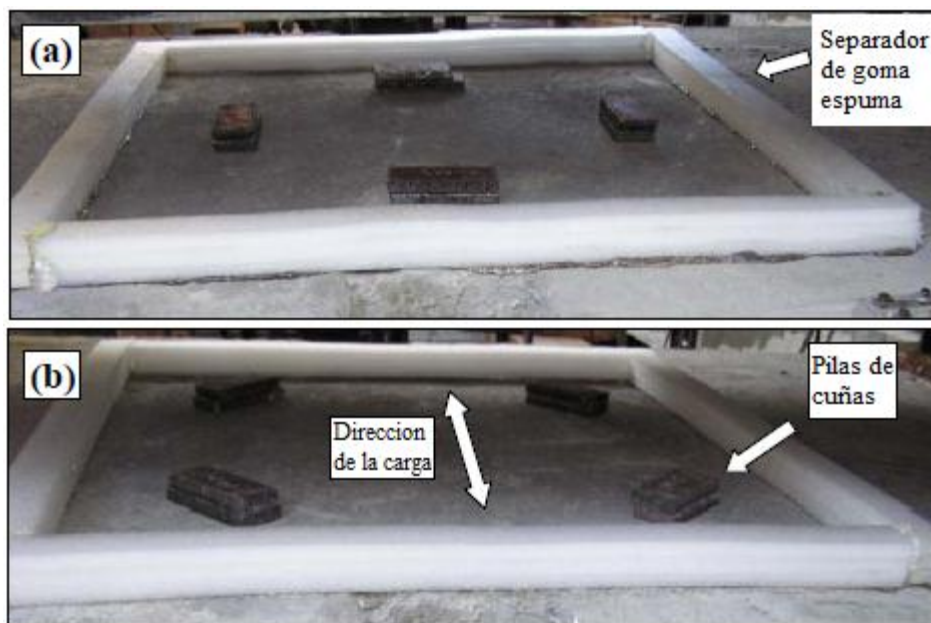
Pilas de Cuñas Posicionadas (a) Ensayo 1 (b) Ensayo 2.
